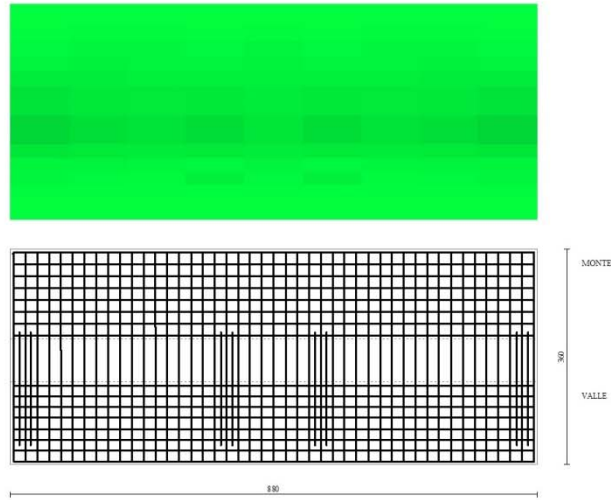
Piastra fondazione dir. Y (Inviluppo)
